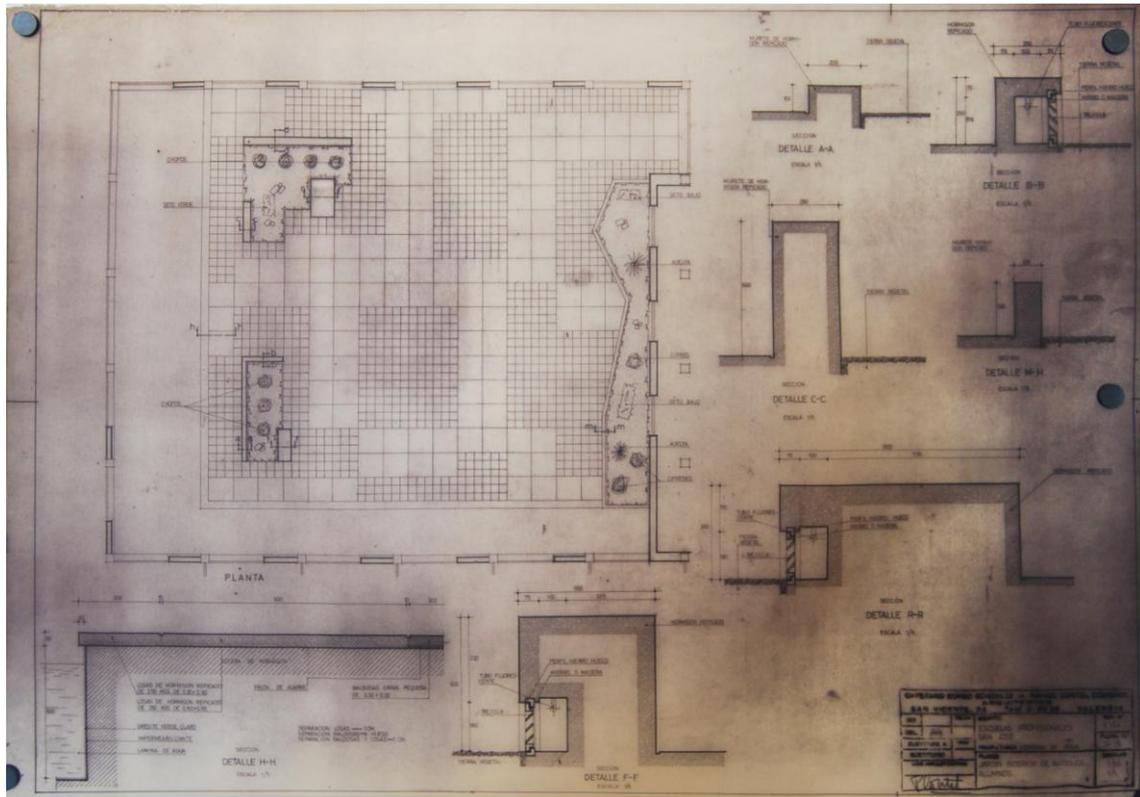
Plano y detalles plaza de antiguos alumnos (pabellón central). Archivo Escuelas San José.
